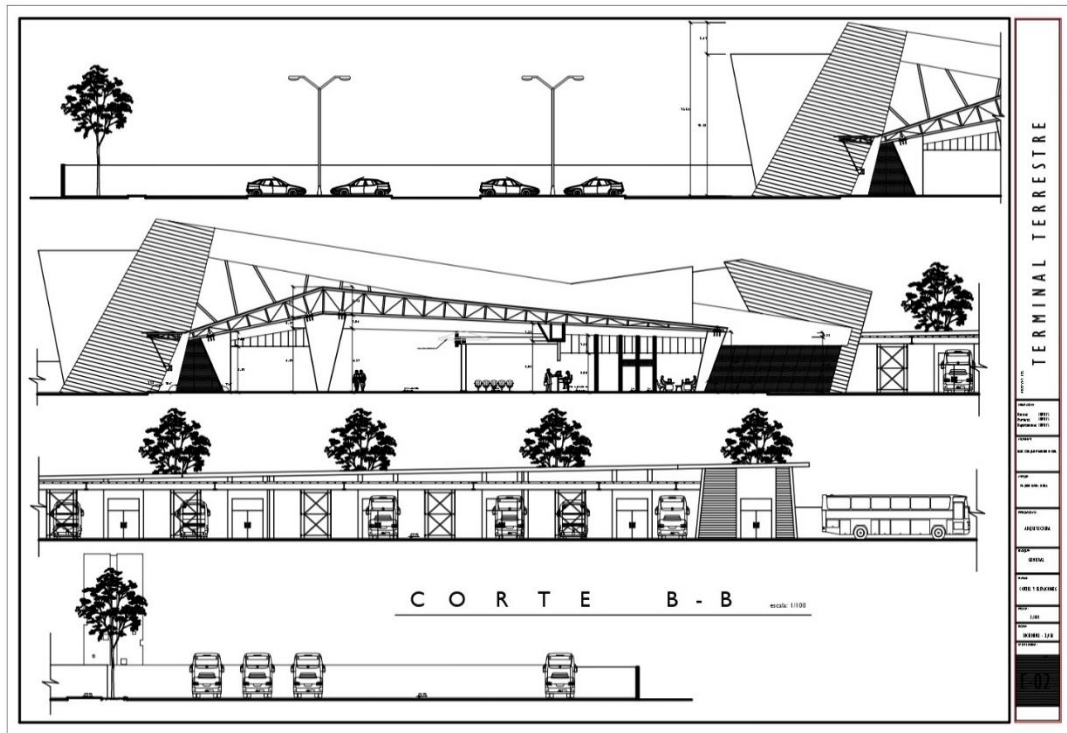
Corte y elevaciones: Corte B – B. Elaboración Propia
